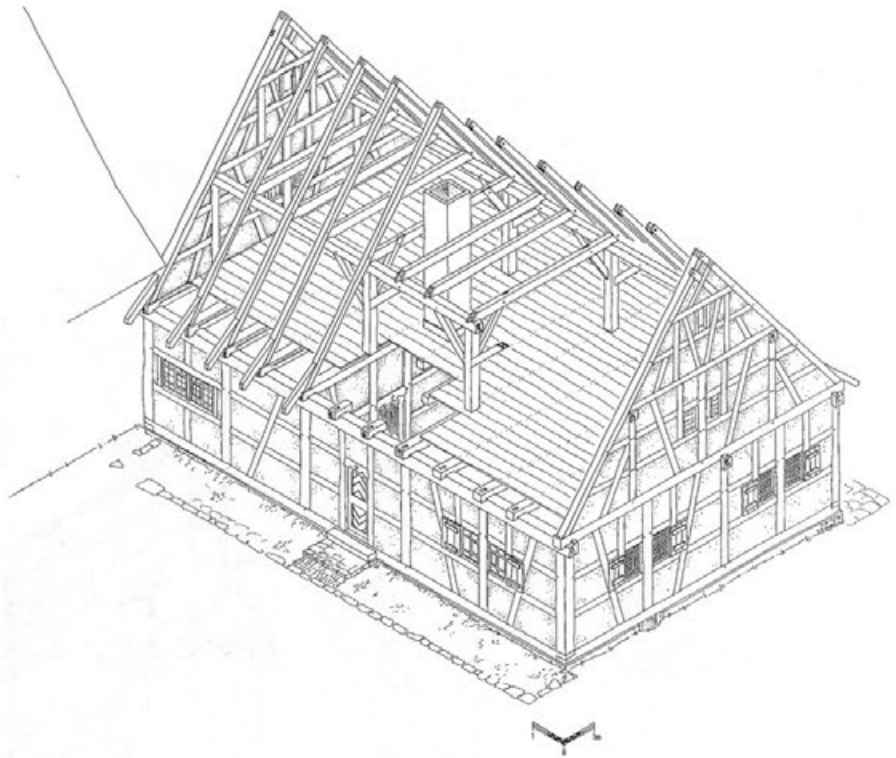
Unterer Bauhof aus Betzenweiler: Rekonstruktionsversuch des Sennhauses. Isometrische Darstellung des Gebäudes mit Blick in den Dachstuhl.
